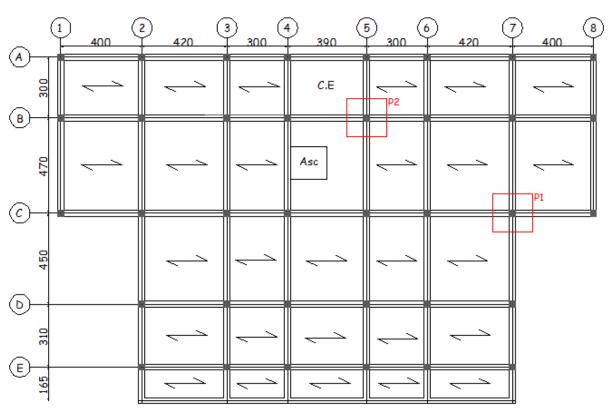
Schémas de la disposition des poutrelles dans étage courant.
